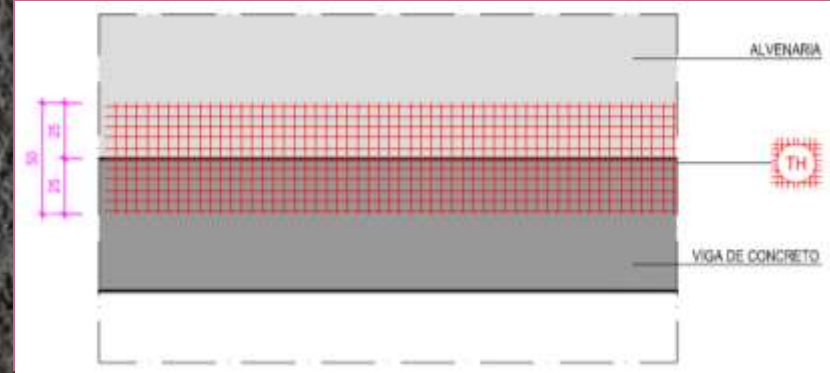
Posicionamento da tela para atenuação de fissuras
